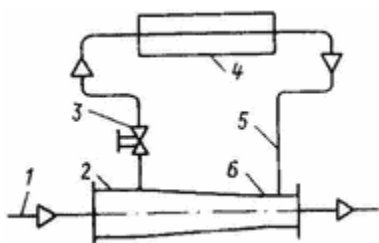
Схема установки эжектора у паровой грелки 1 — магистраль парового отопления; 2 — эжектор; 3 — регулирующий запорный клапан; 4 — паровой радиатор; 5 — отвод пара с конденсатом; 6 — горло эжектора
